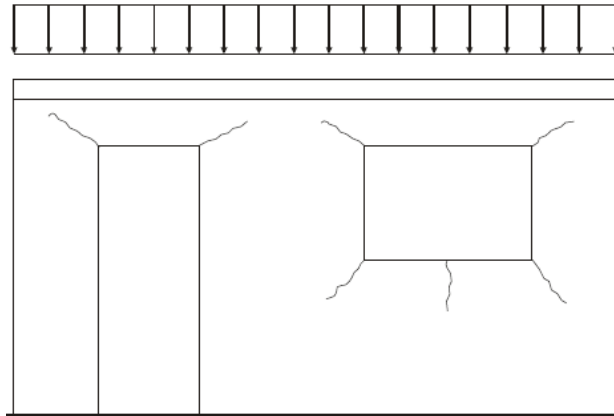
Fissuras devido a carregamentos excessivos de compressão
